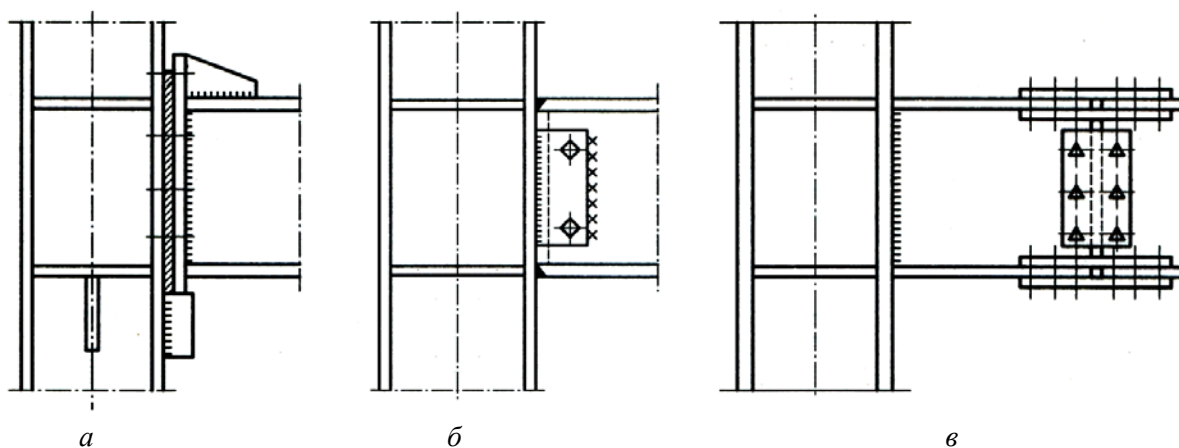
Жесткое сопряжение ригеля с колонной при помощи опорного фланца (а), сварки поясов и стенки (б), накладок и консоли на колонне (в)
